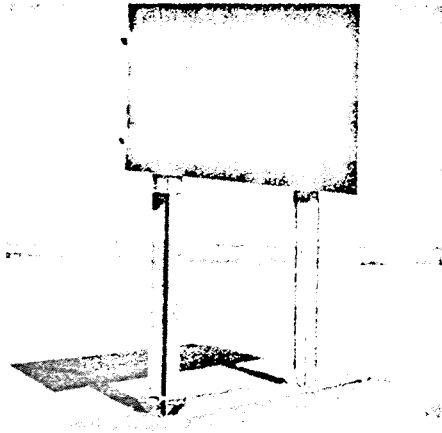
Schuifconstructie van één der vier kolommen.
